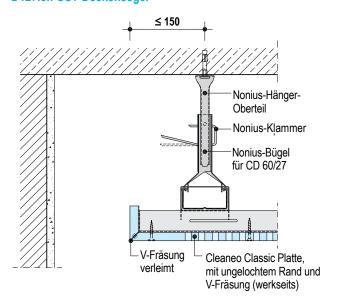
ch-SO14 Anschluss Decke an Vorsatzschale
